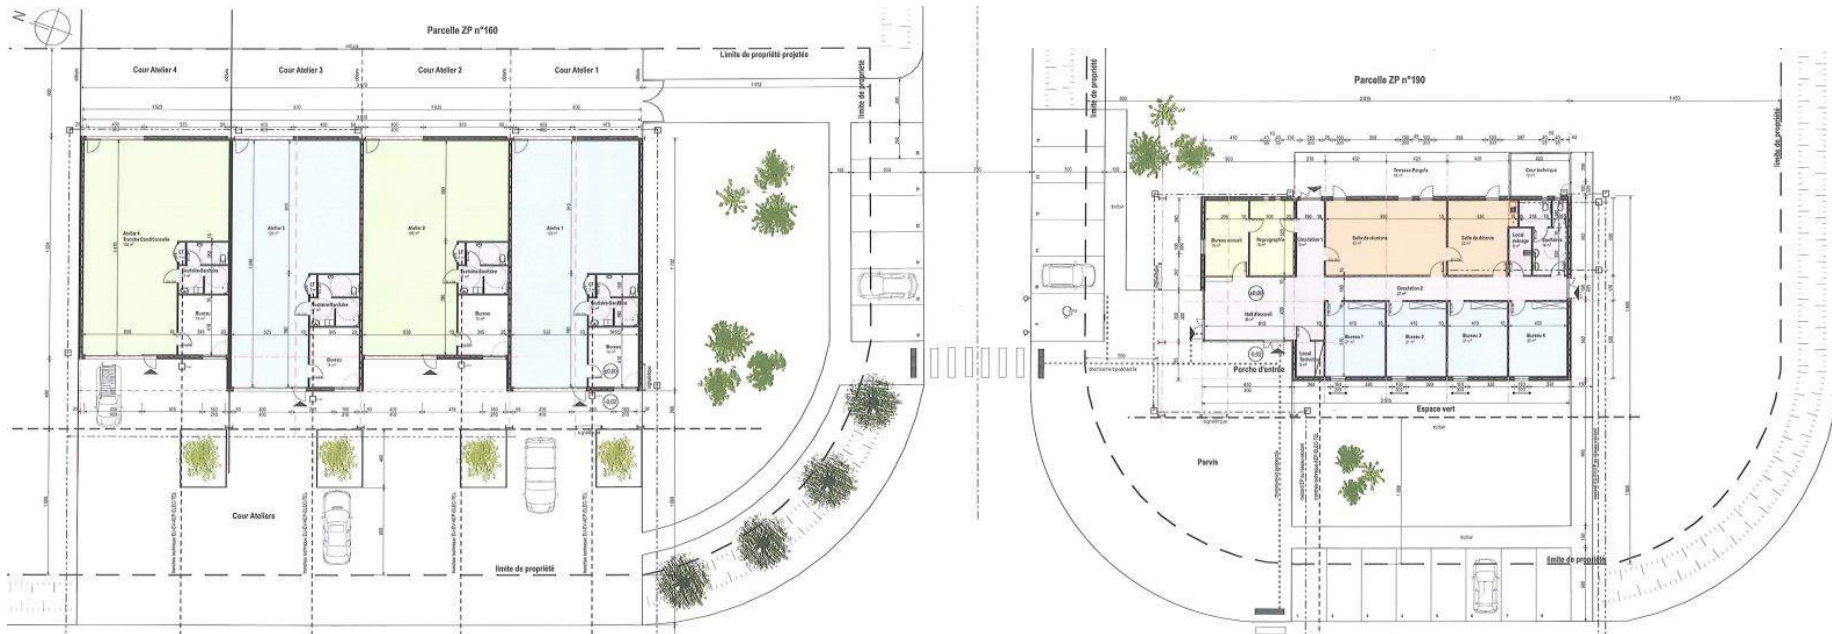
Plan du projet de Village d'entreprises sur la ZAE de Gouneau, par Archi Studio.
